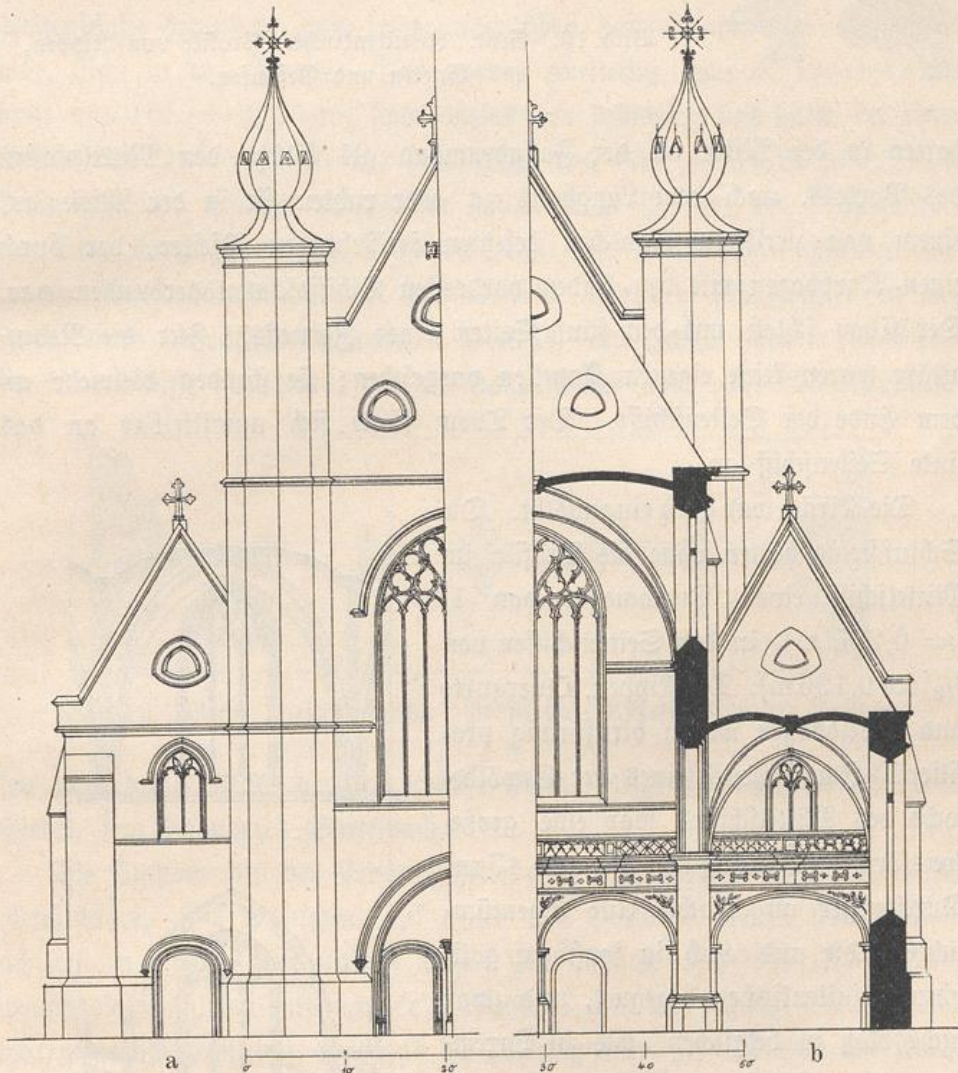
Gent. Jesuitenkirche. a Fassade, b Querschnitt (Rekonstruktion).
